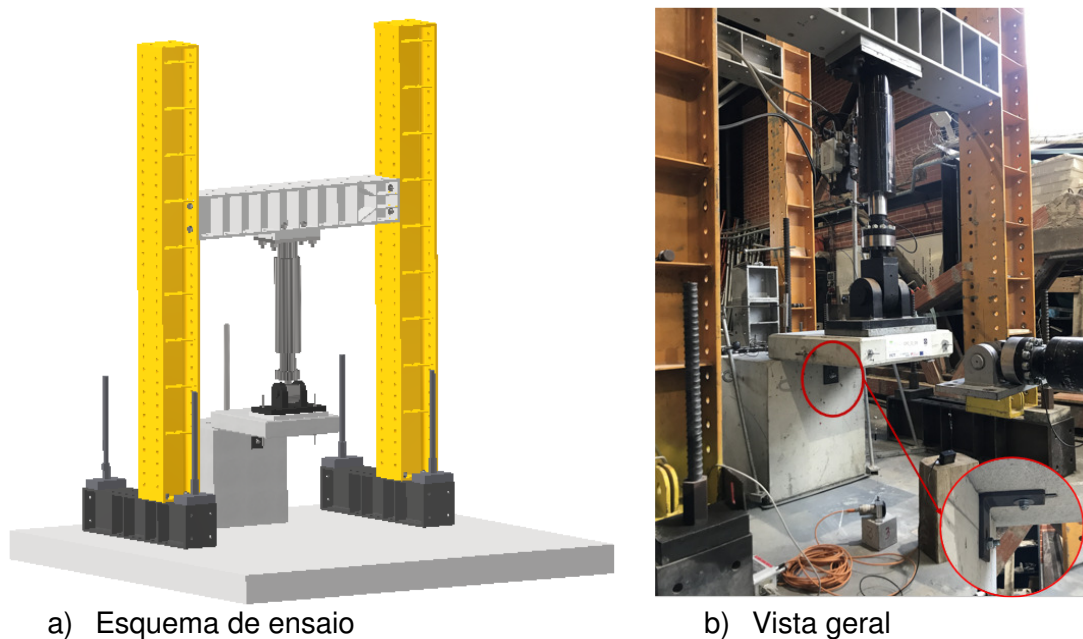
Setup de ensaio fora do plano de ligações painel-pilar.
